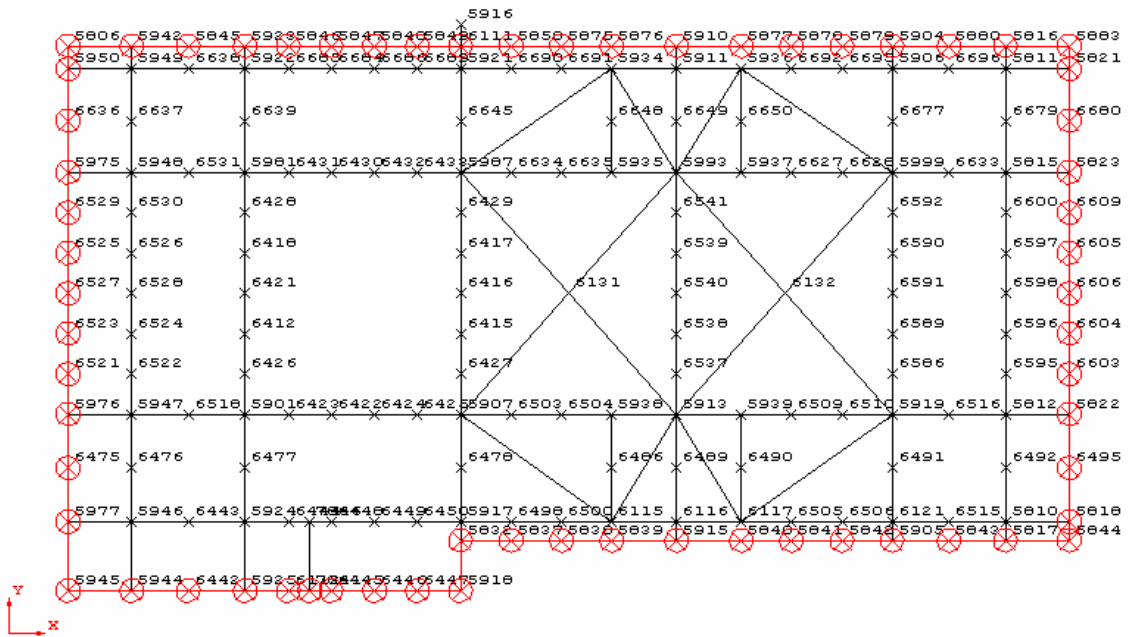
Barandales – Miembros de aplicación – Cubierta inferior.
